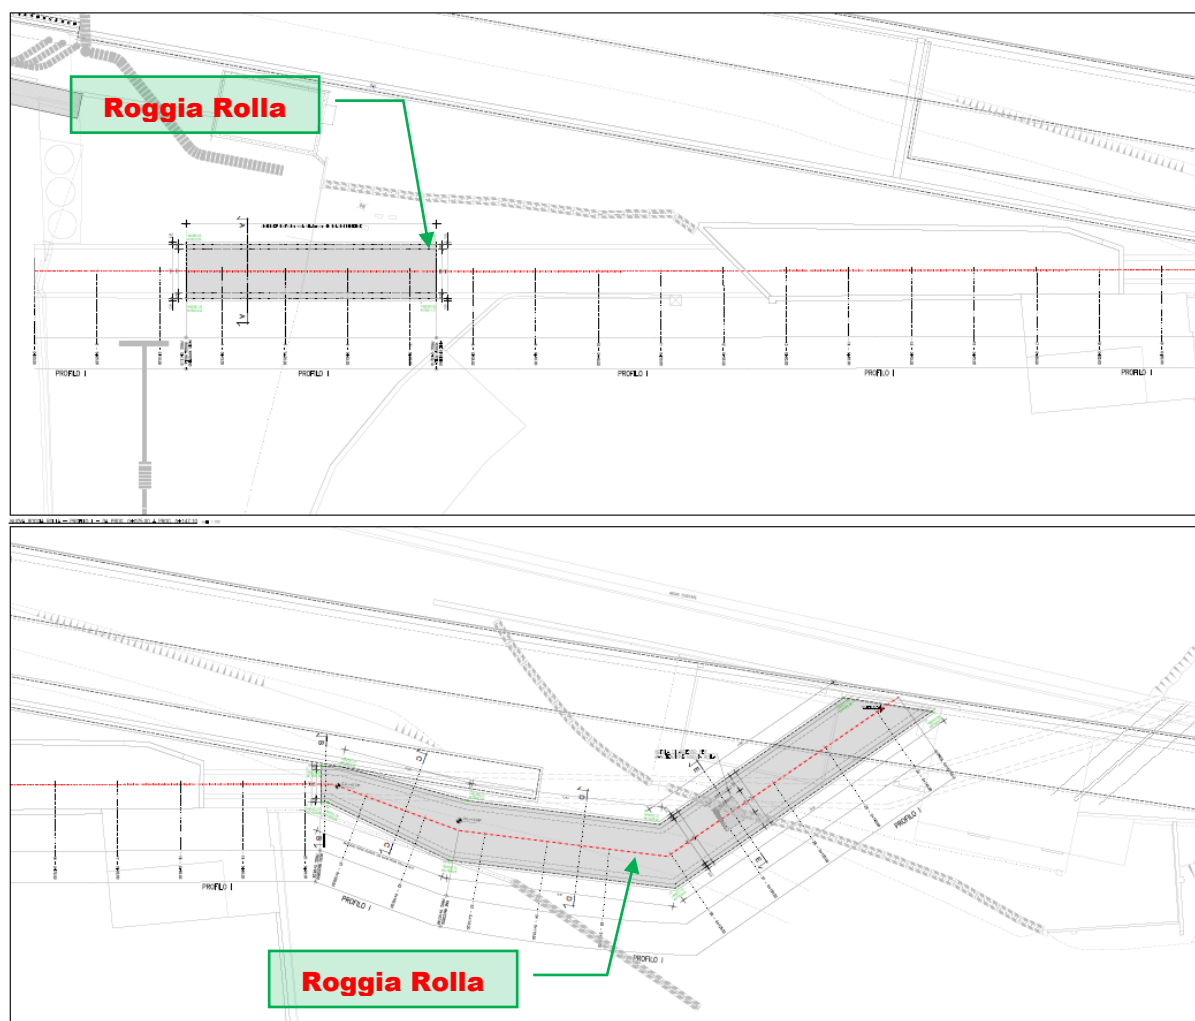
Planimetria muri e solettone di fondo tratto di monte
